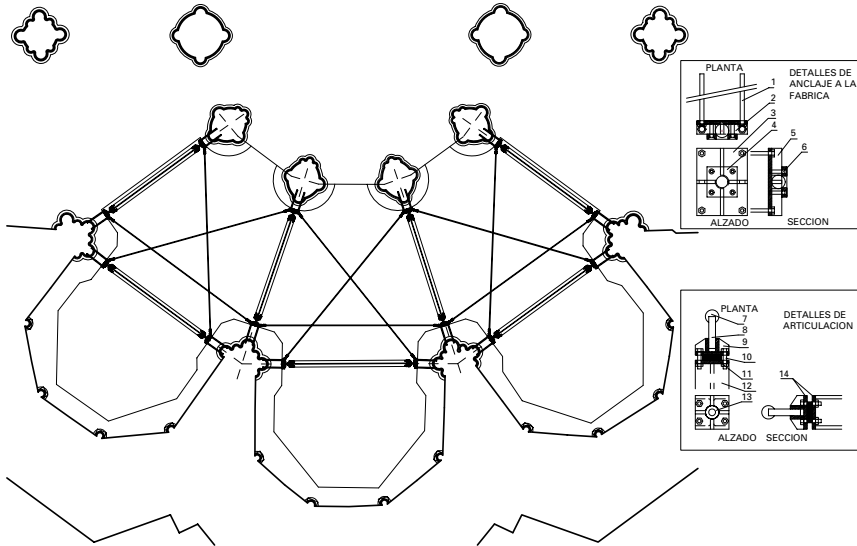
Planta y detalles del acodamiento de los muros y cimentaciones descubiertas en la excavación arqueológica
